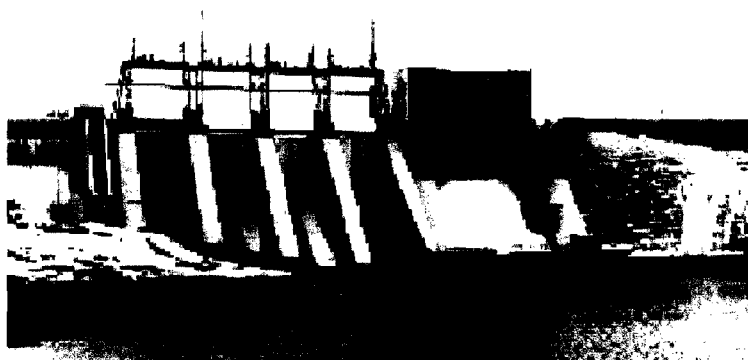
Vue de l'aval du barrage en construction (vers 1930)
